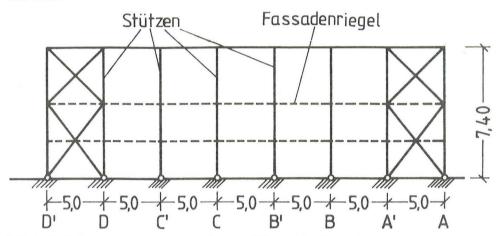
Randstützen der Halle mit Stabilisierungsverbänden
